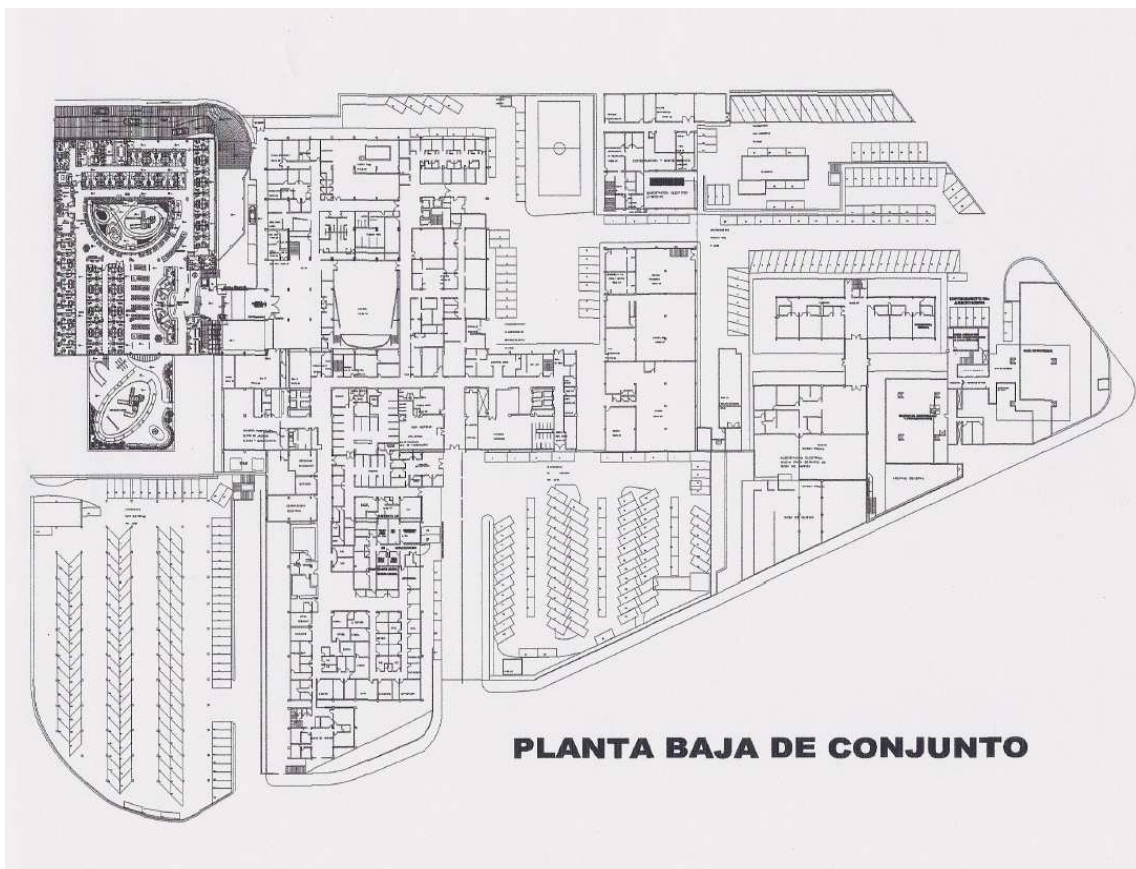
Planta baja de conjunto del Instituto Hospitalario
